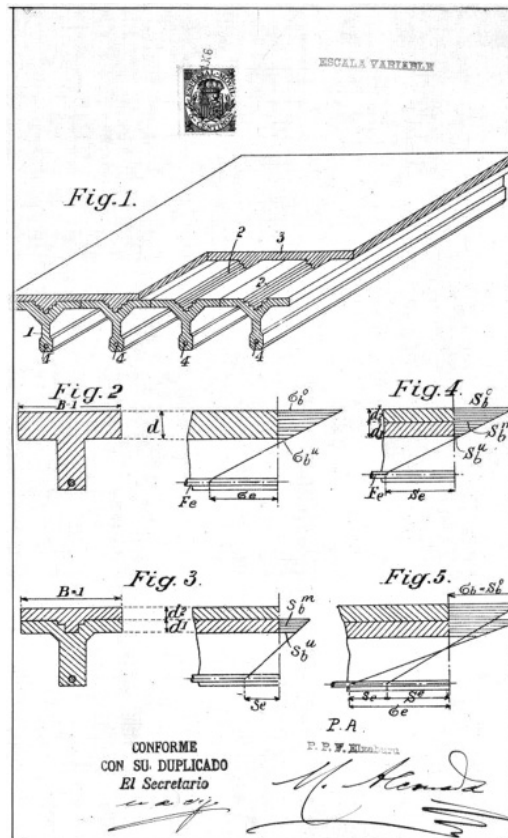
Bayer, patente española número 38624, plano 1/1, 1906
